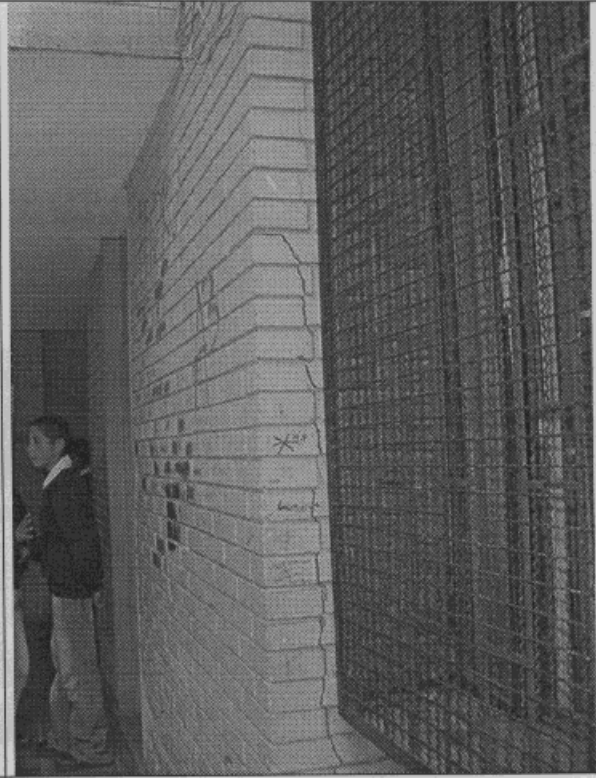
Agrietamiento vertical en muro de mampostería del primer piso, sector oriental.
